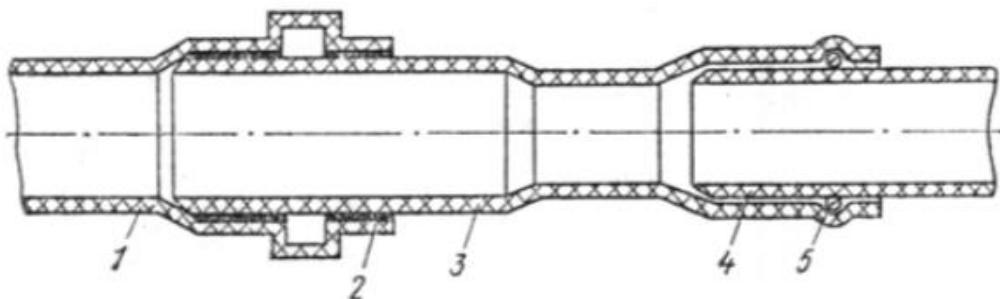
Узел соединений раструбного конца детали из ПВХ с гладким концом полиэтиленовой трубы 1 — раструбный конец с желобком детали из ПВХ; 2 — kleевой шов; 3 — переходной патрубок из ПВХ; 4 — гладкий конец полиэтиленовой трубы; 5 — уплотнительное кольцо из резины марки 3311
